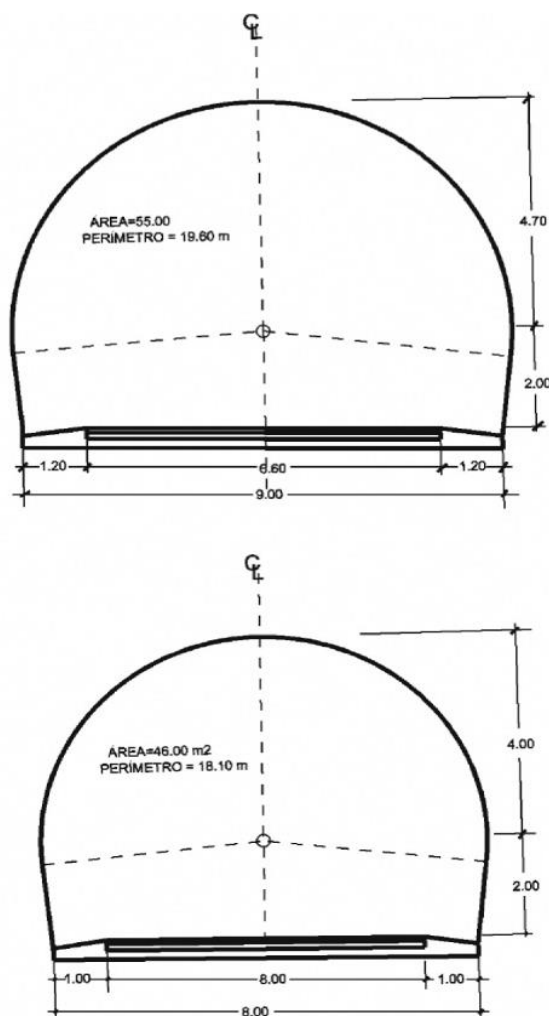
Altura Libre en Túneles (Fuente: MTC: Manual Para el diseño de Carreteras no Pavimentadas de Bajo Volumen de Transito)
